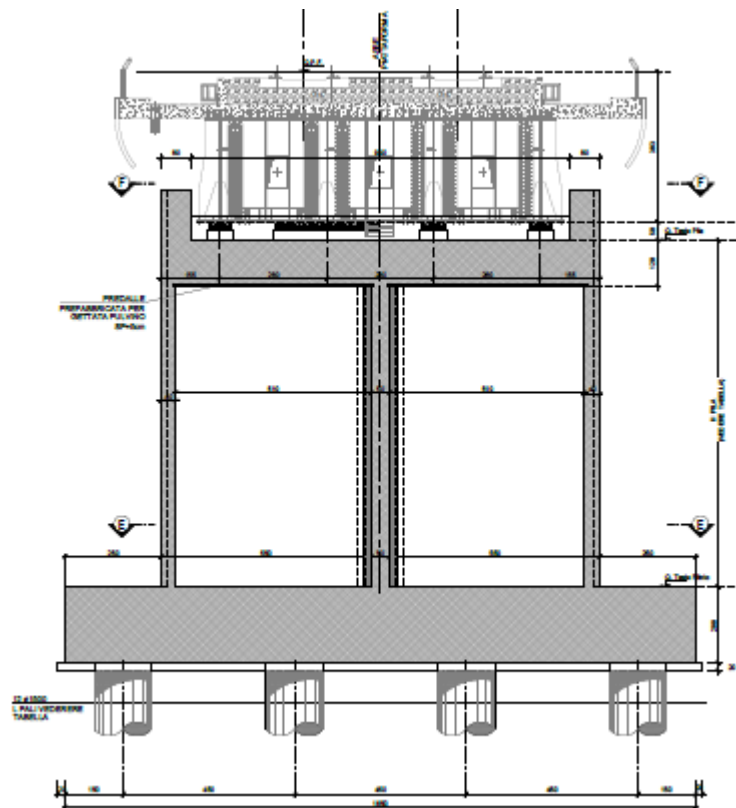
Sezione in direzione trasversale rispetto all'asse del viadotto
